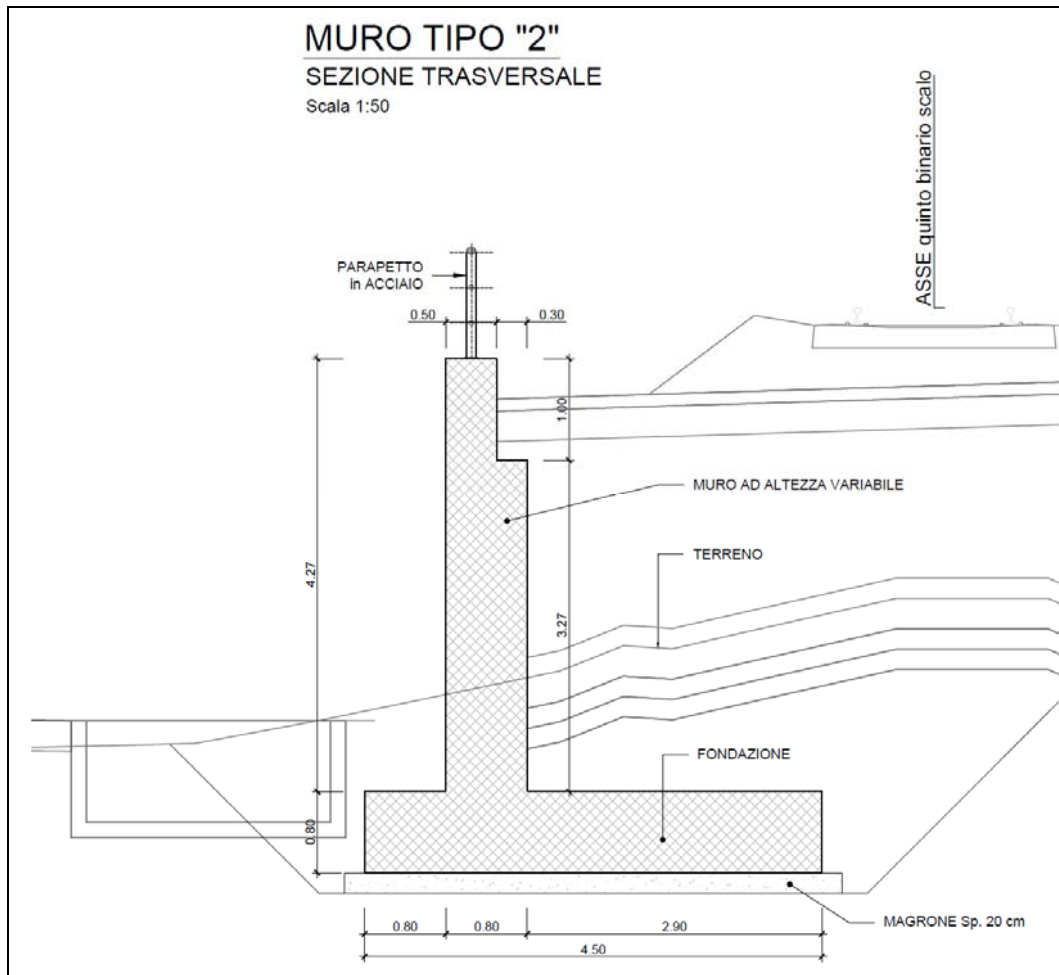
Sezione trasversale del muro MU08: tipo 2.
